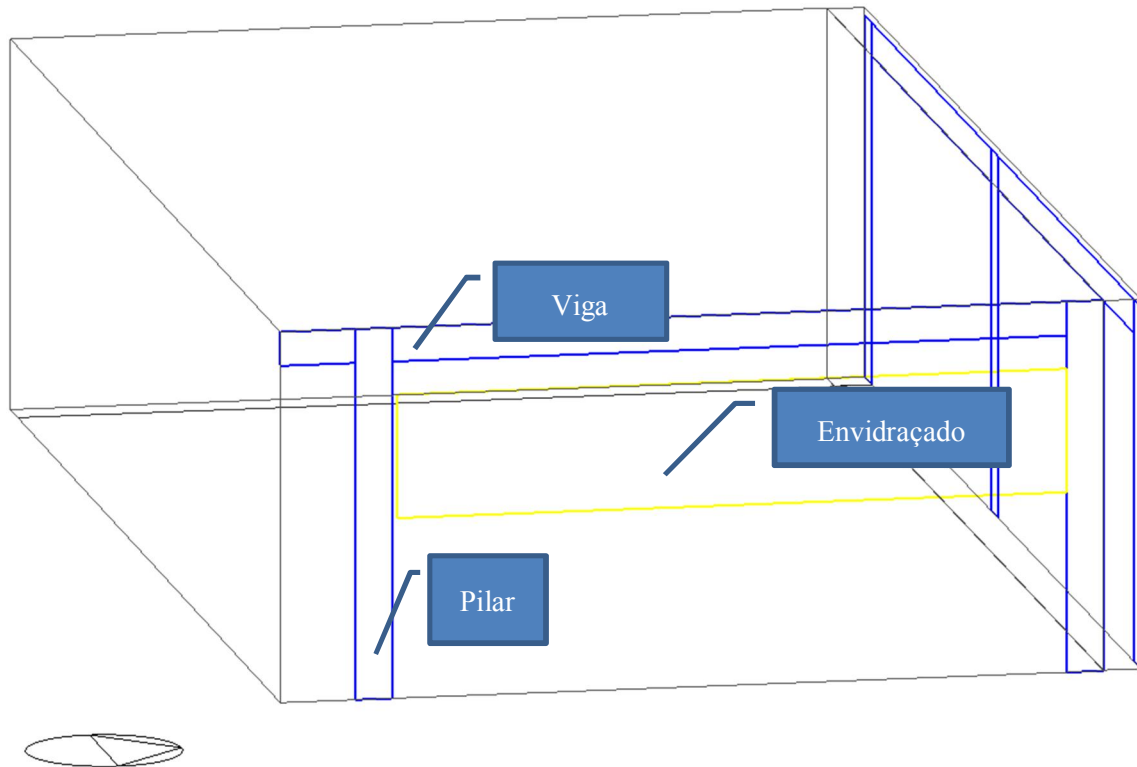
Layout dos elementos construtivos da Sala E1
